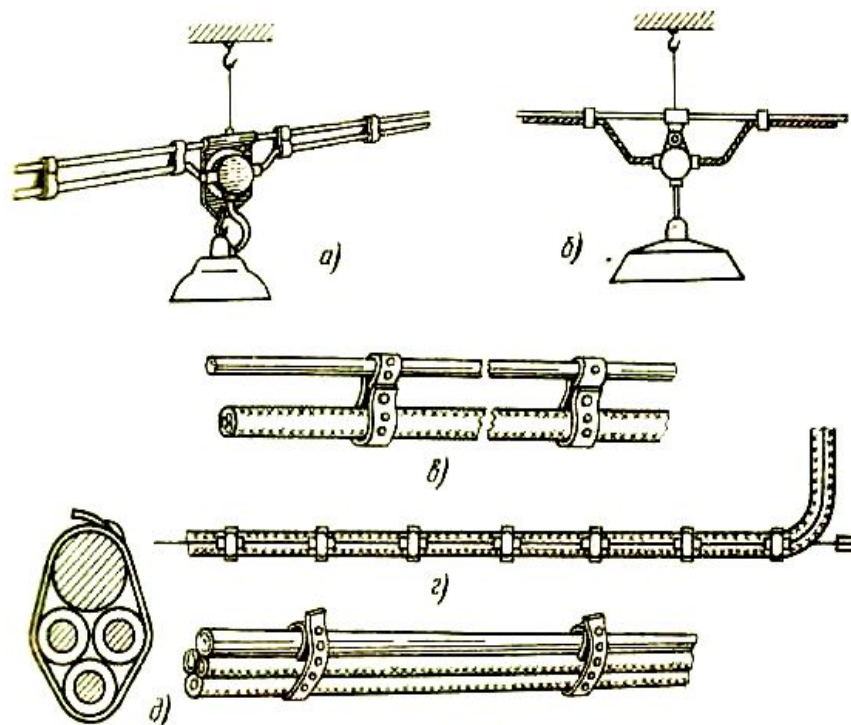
Примеры выполнения электропроводок с подвеской кабелей на тросе или струне: а – с креплением тросовым зажимом ISO; б-д – с креплением бандажами из стальных и пластмассовых полосок с пряжками и кнопками
